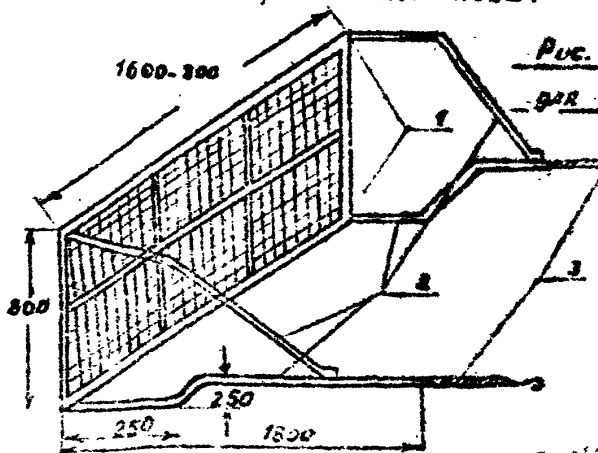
Переносная инвентарная скелетная конструкция участка работ на кровле
